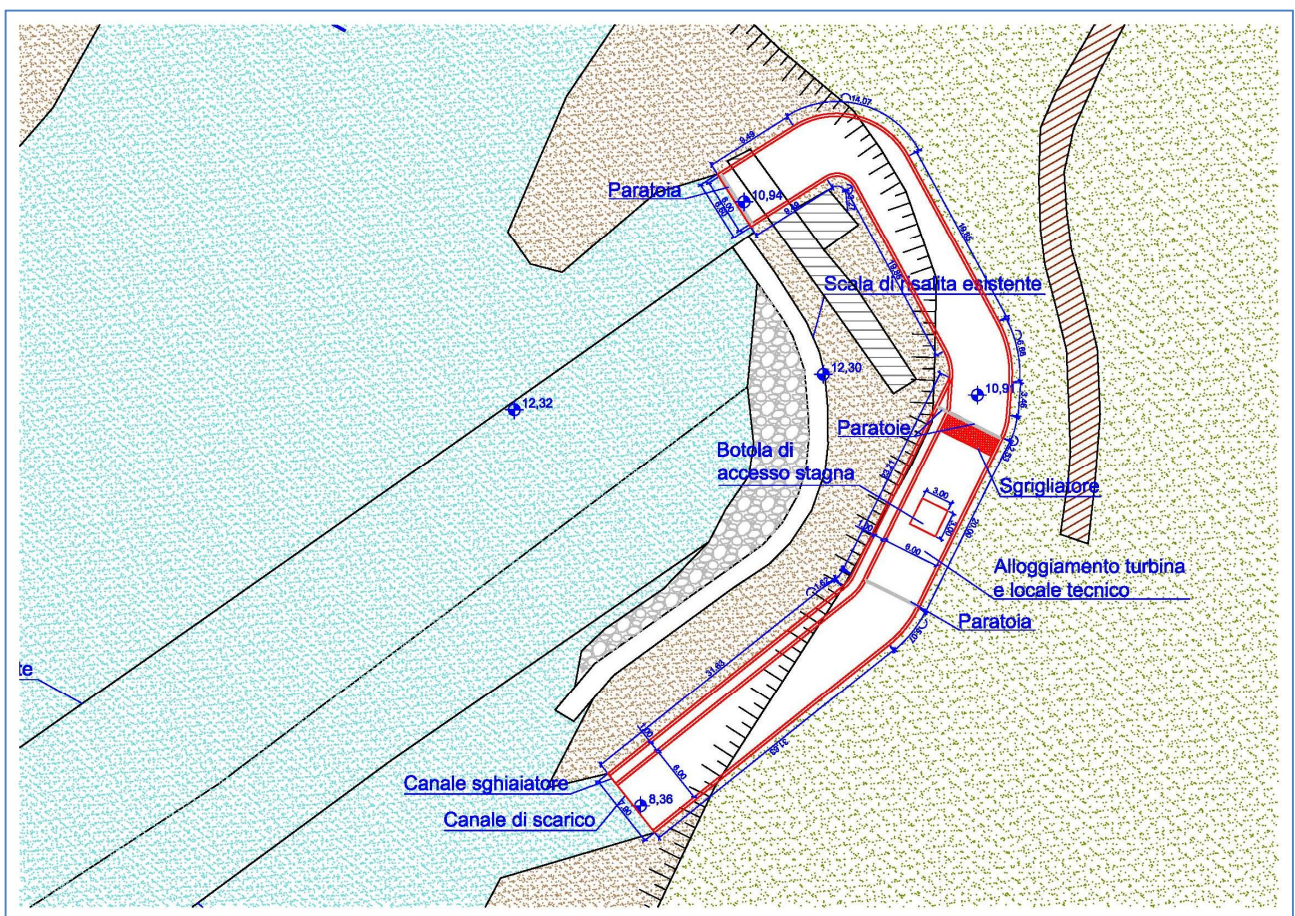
Sezione planimetrica Progetto centrale idroelettrica “La Steccaia”
